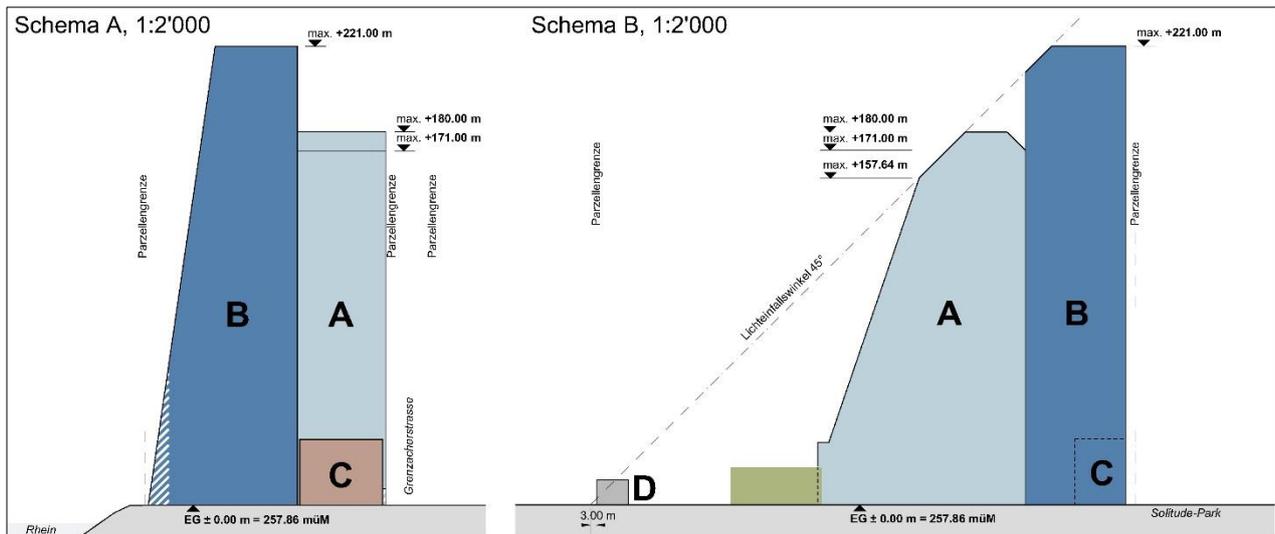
Auszug aus dem neuen Bebauungsplan. Schema A und B (Kein Massstab, Plan genordet)
